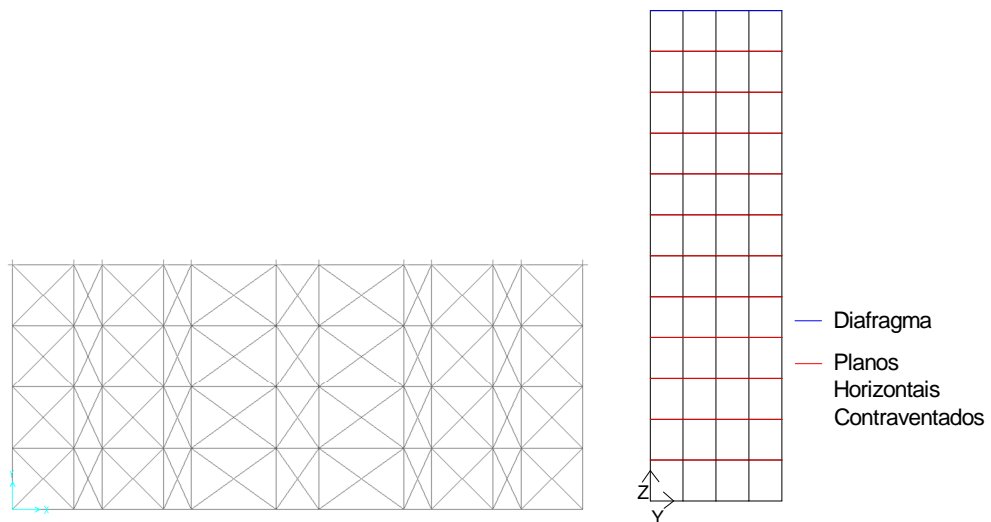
Configuração dos Planos de Contraventamento Horizontal Com Elementos de Contraventamento Pequenos
